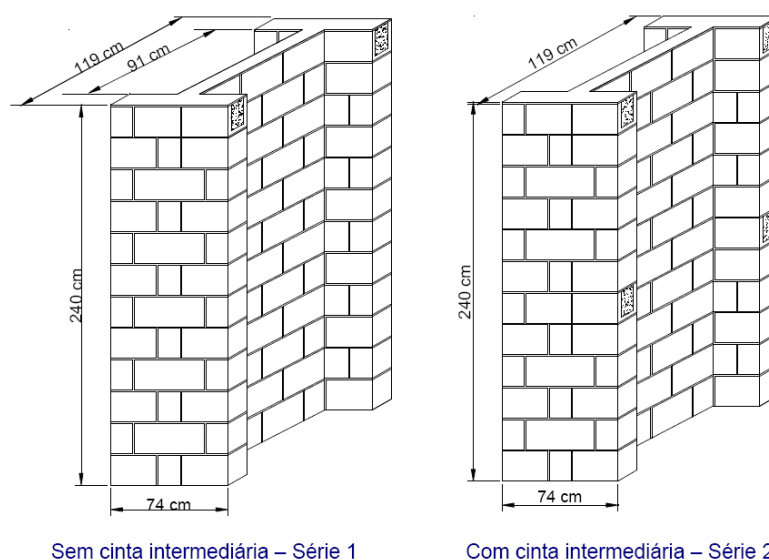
Painéis de alvenaria ensaiados por (CAPUZZO NETO, 2000).
